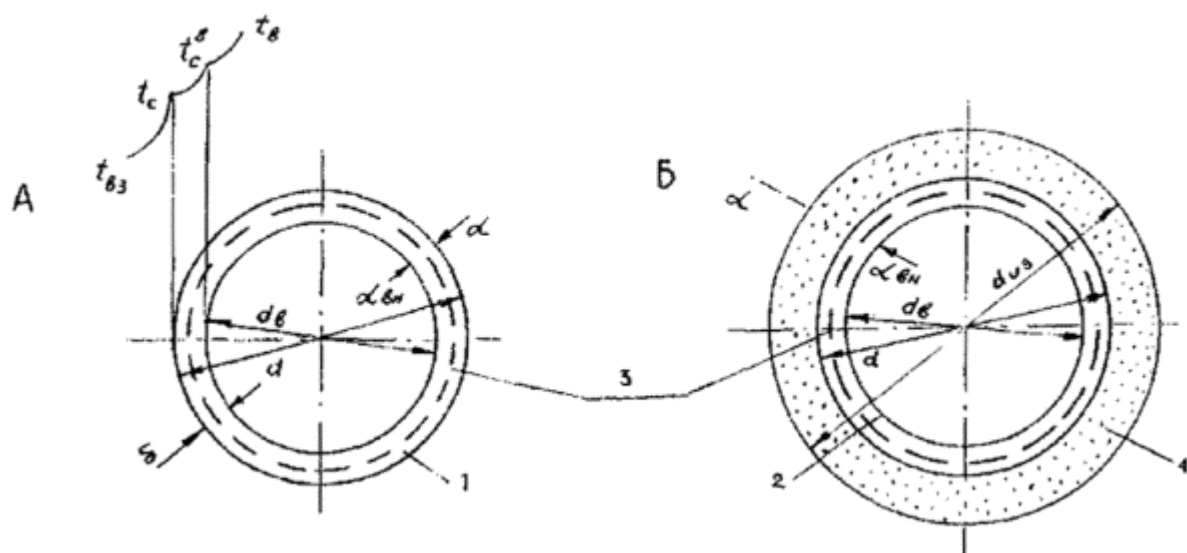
Схема металлополимерной трубы для расчета теплопередачи через цилиндрическую стенку:
